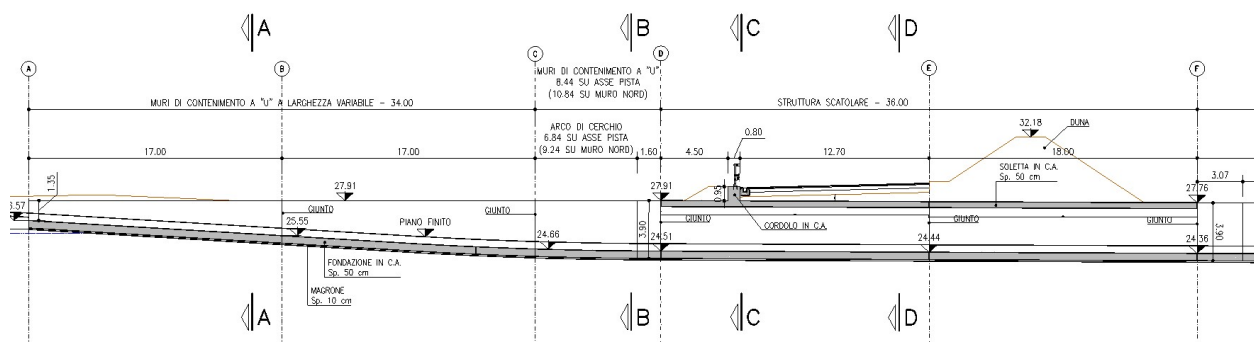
7: Sezione longitudinale dei muri ad U e sottopasso lato ovest
